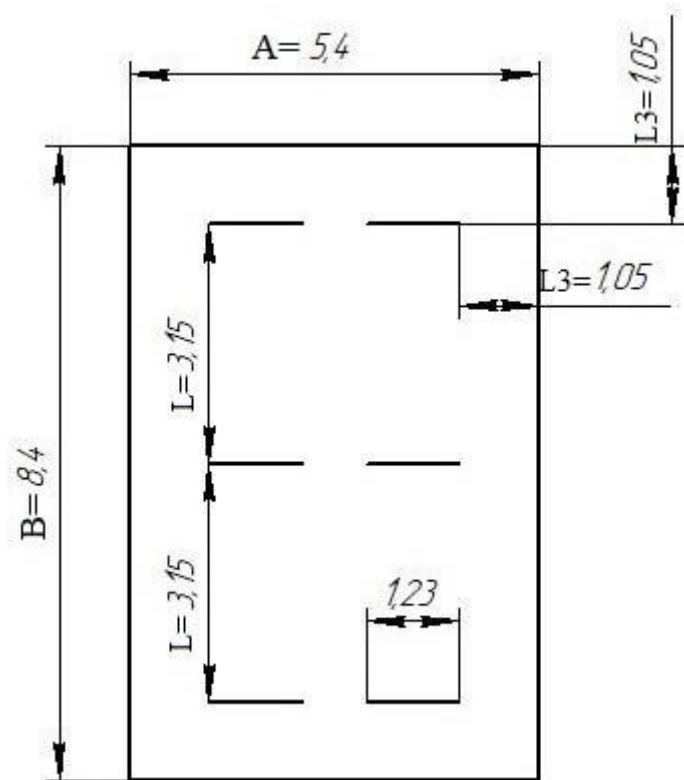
План помещения и размещения светильников с люминесцентными лампами
